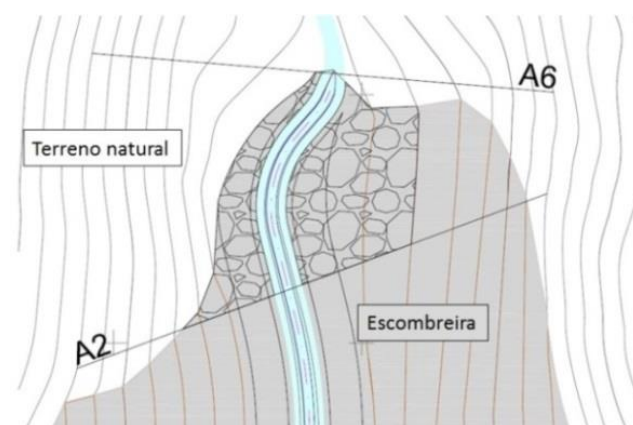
Planta geral da obra de ligação do afluente ao canal 2.
